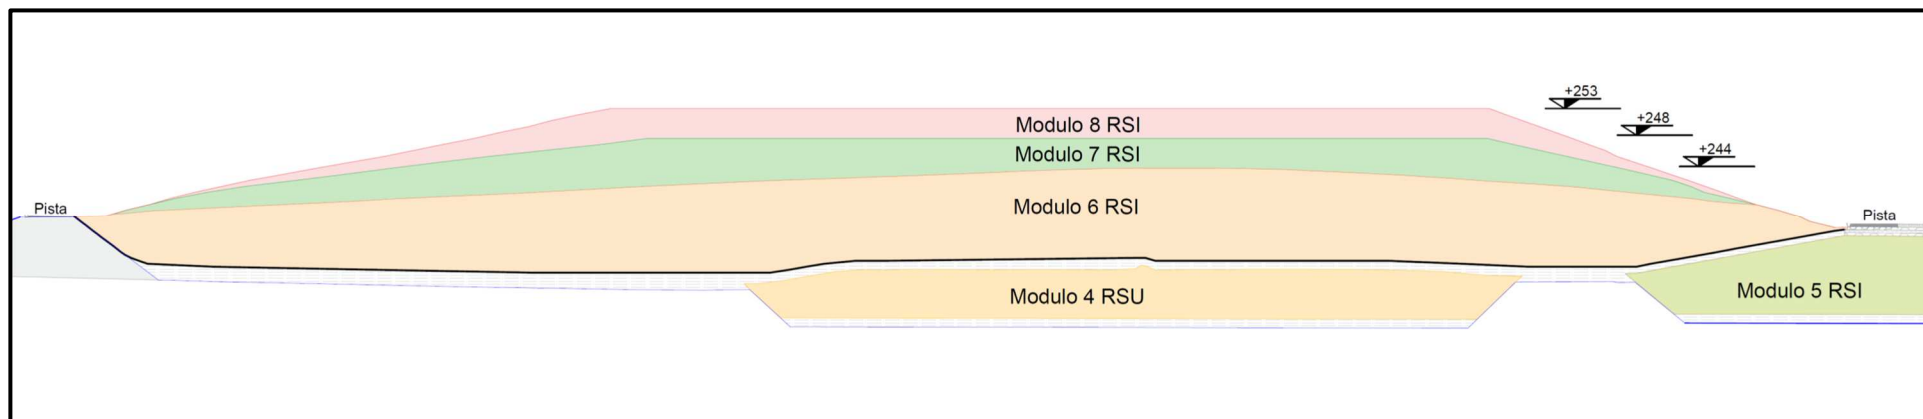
/I: Sezione tipo sovrapposizione moduli
